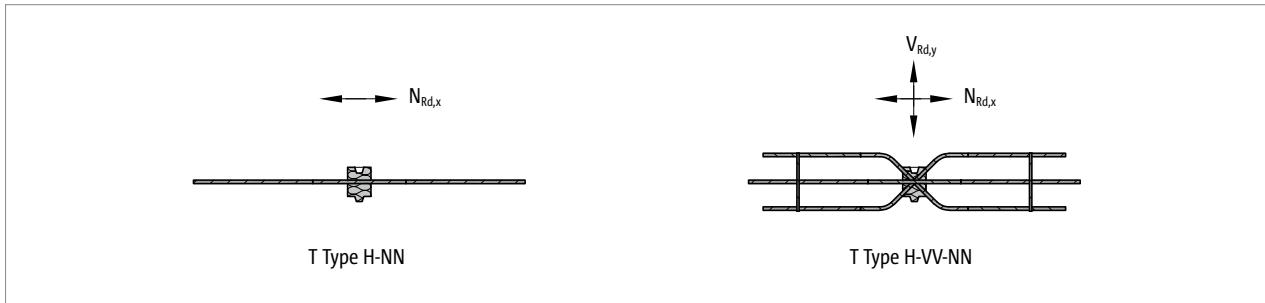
Schöck Isokorb® T Type H : Sélection du type
